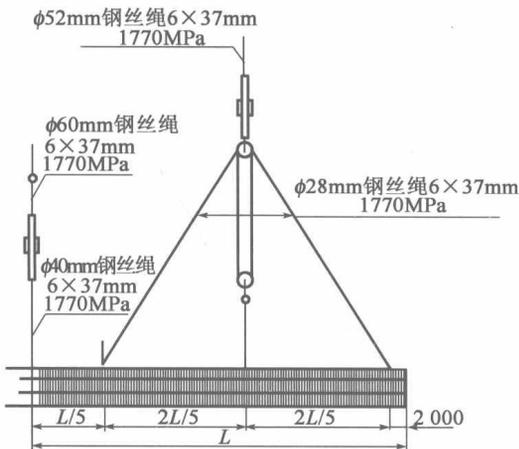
钢筋笼吊点示意图(尺寸单位:mm)
